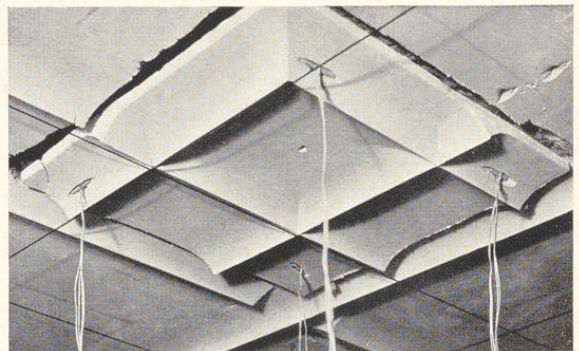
Versetzen eines in der Spiegelleimform gegossenen Kassettenstücks. Befestigung mit Draht
